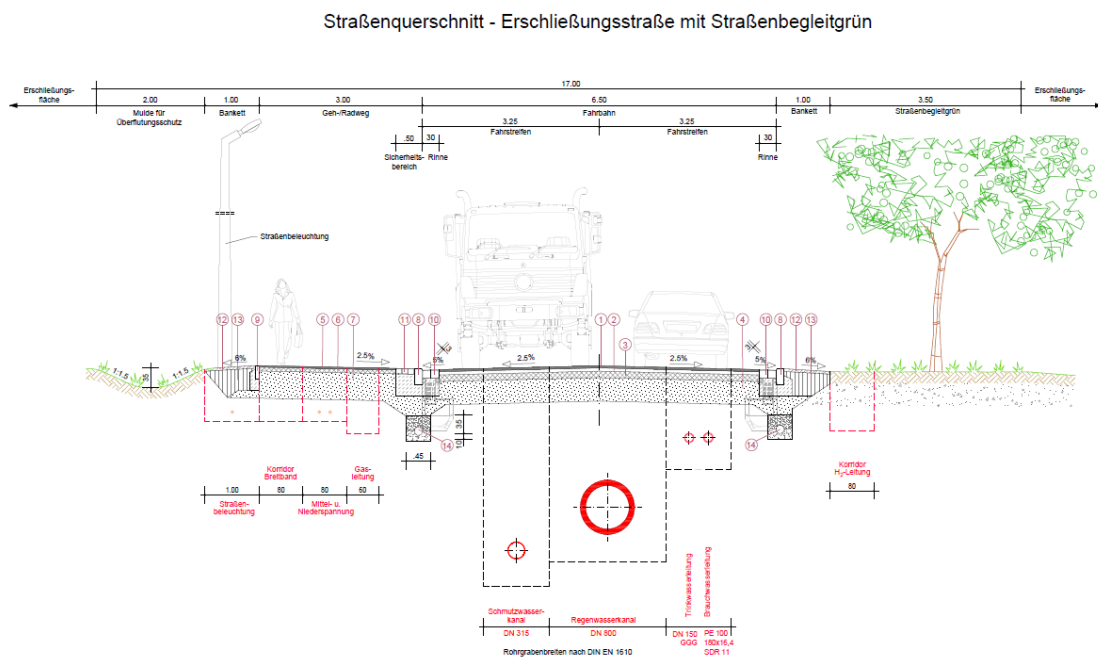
Straßenquerschnitt Erschließungsstraße
